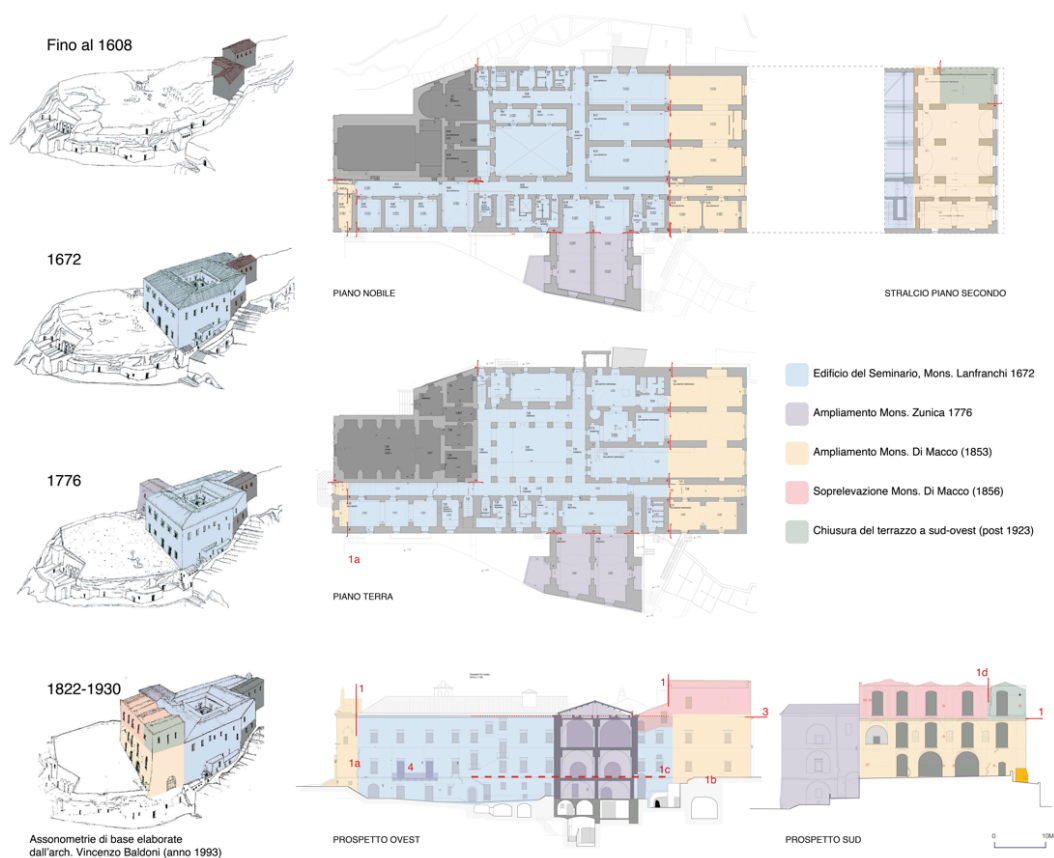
Sintesi delle fasi costruttive. Pianta del piano terra, prospetto ovest e prospetto sud, viste assonometriche. Le assonometrie sono desunte dal progetto di Baldoni, ma sono qui reinterpretate criticamente (attraverso campiture) a valle dei riscontri sul campo e dell'analisi delle fonti.
